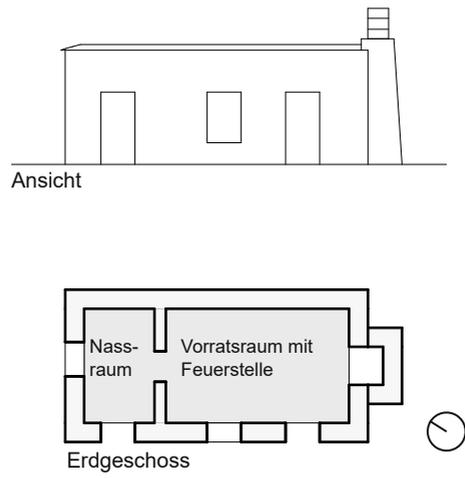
Ansicht und Grundrisse von dem untersuchten Objekt (Tandır) in Gemeçik | 1:200
